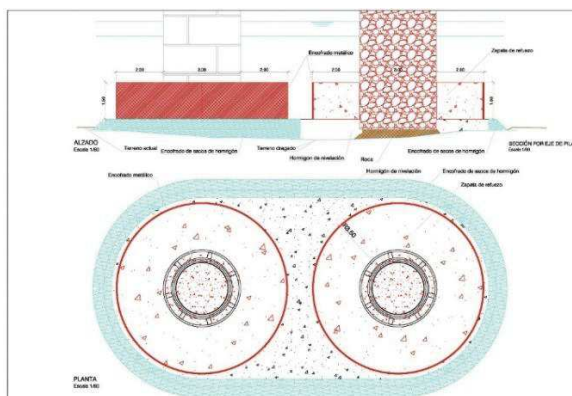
2. Solución refuerzo de pilas puente de Hierro de Logroño
